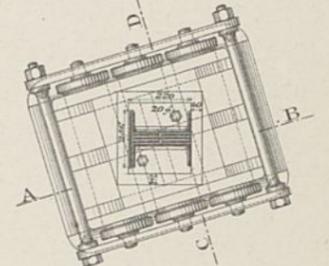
Grundriss des Rollenlagers des Binders 31. 1: 25.
